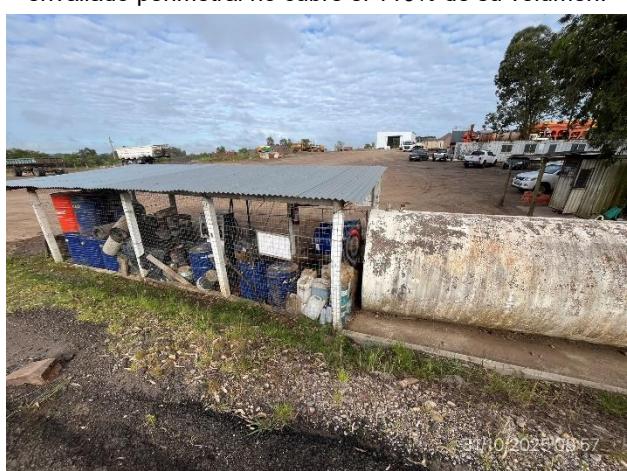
, P02. Recinto de acopio de lubricantes cerrado, techado y con envallado perimetral estanco.
